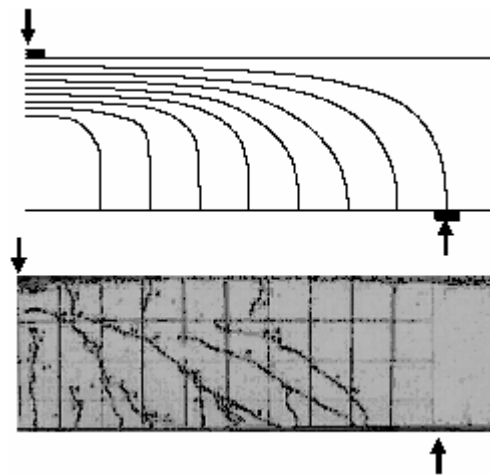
Trayectorias de tensión principal de compresión en una viga no fisurada y fotografía de una viga de hormigón fisurada a cortante
